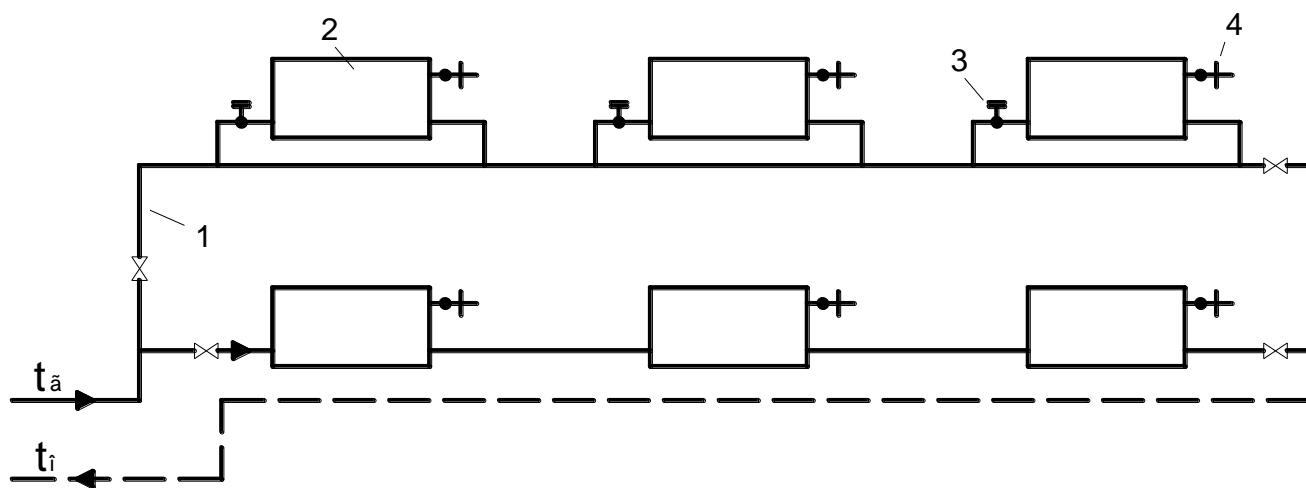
Схема горизонтальной однотрубной системы отопления
